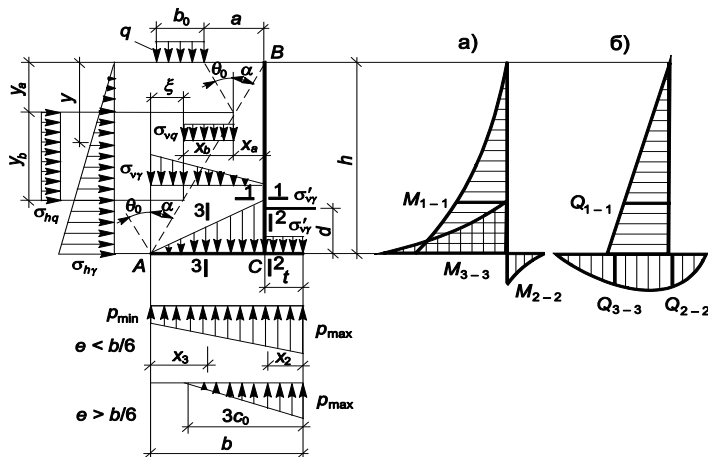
Расчетная схема подпорной стены уголкового типа при расчете ее на прочность:
